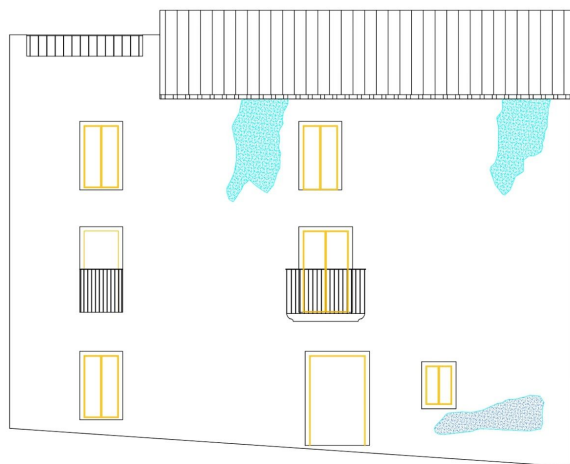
Croquis del estado actual de la fachada principal. (Fuente: Propia)
